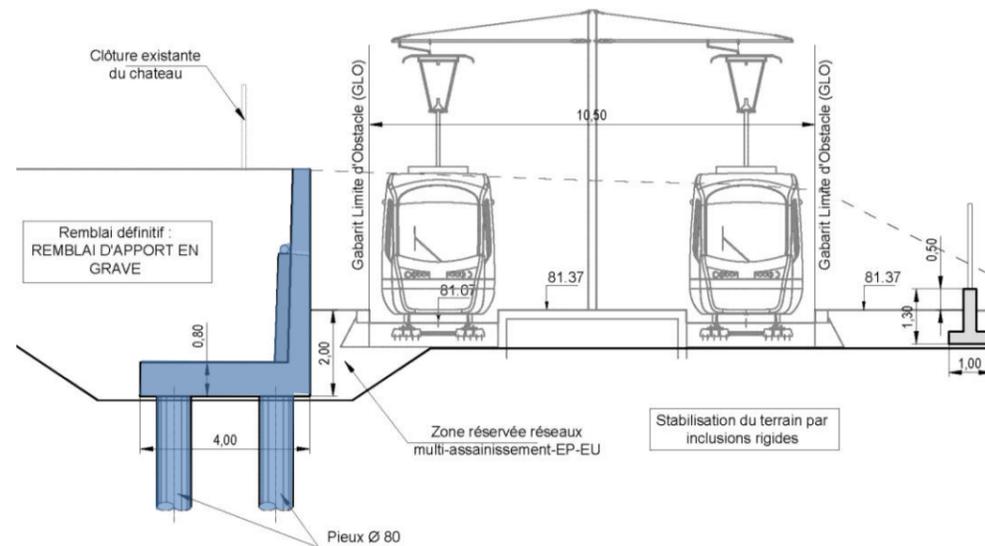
Coupe transversale du mur haut sur fondations profondes (Source : AVP- juillet 2015)
